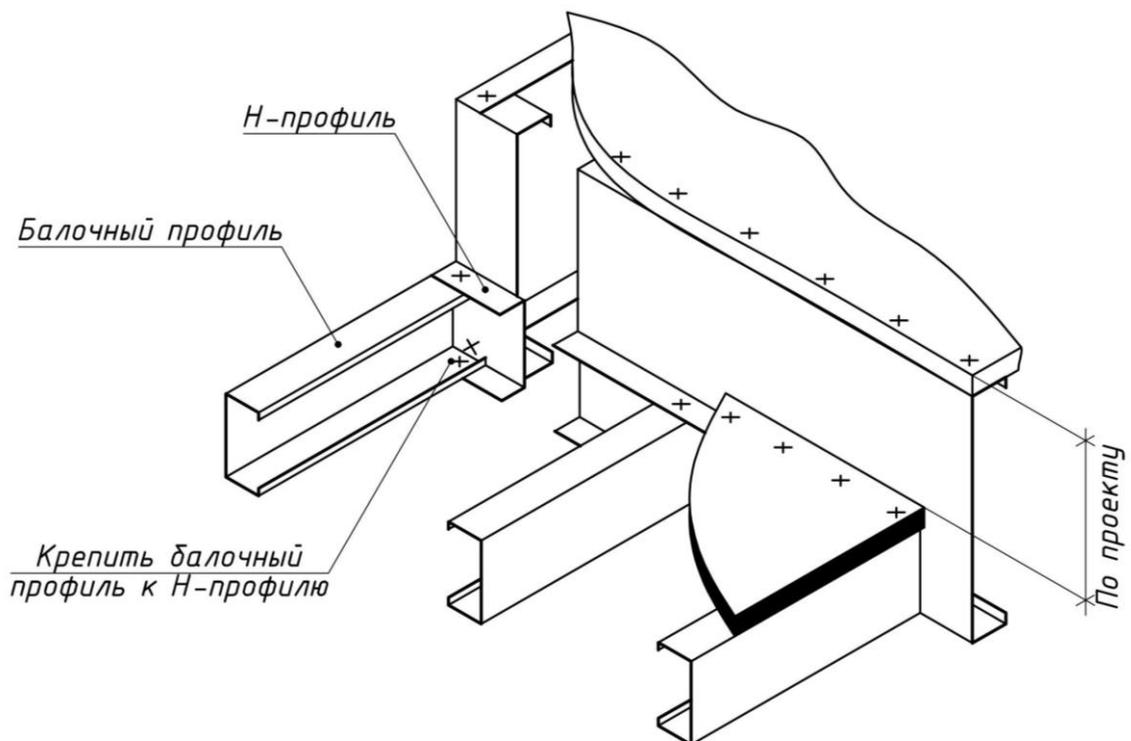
Узел Д 4. Крепление ступени к лестничной площадке
